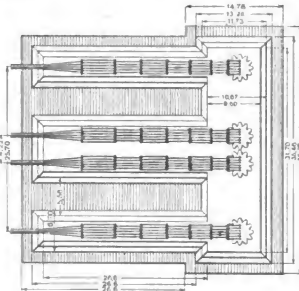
Kabel-Verankerung (Grundriss).
